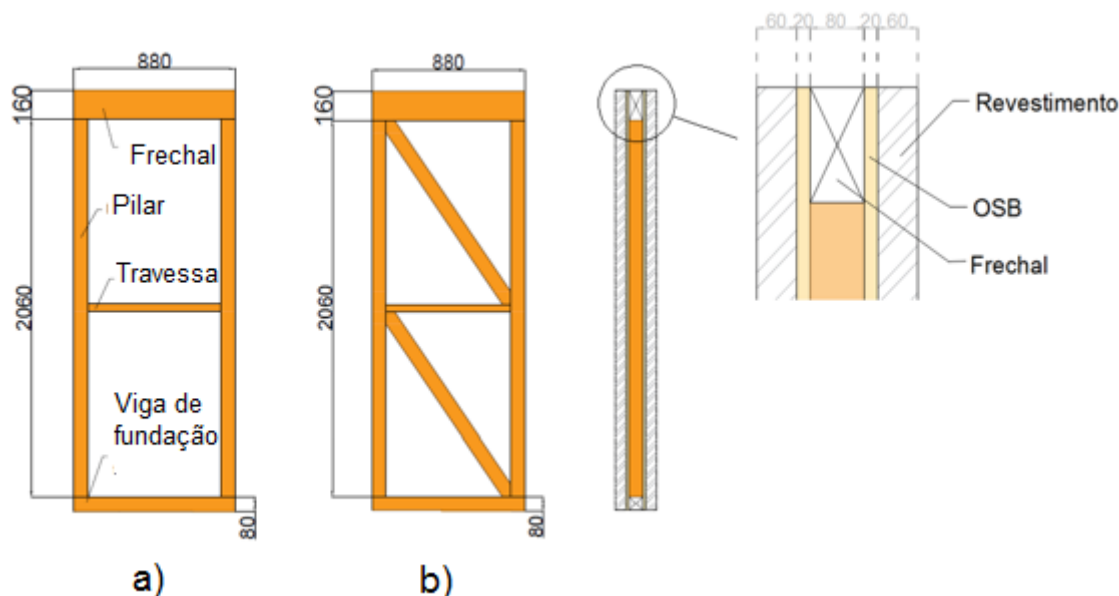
a) Painel das paredes exteriores e interiores; b) Painel das paredes estruturais à direita (medidas em mm)
